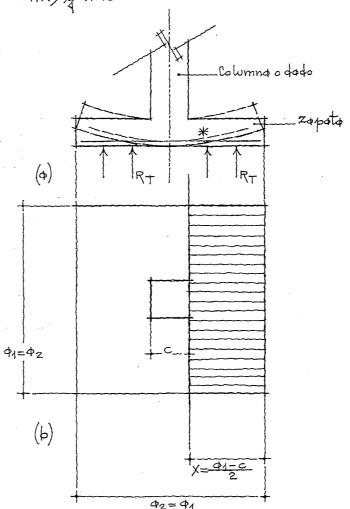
Flexión en la zapata y posibilidad de deslizamiento de las varillas, (a).
